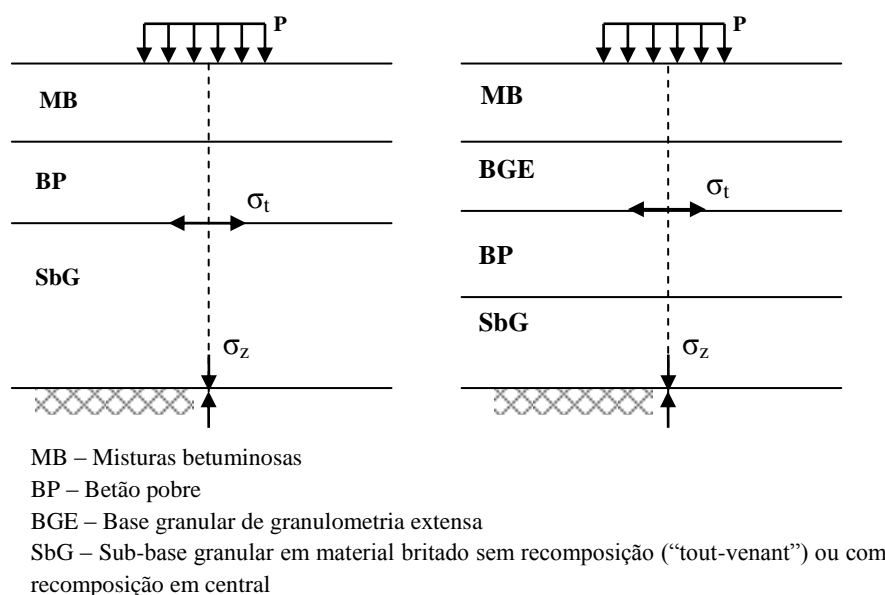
Pavimento semi-rígido: constituição e comportamento (adaptado de Branco *et al*, 2005)
